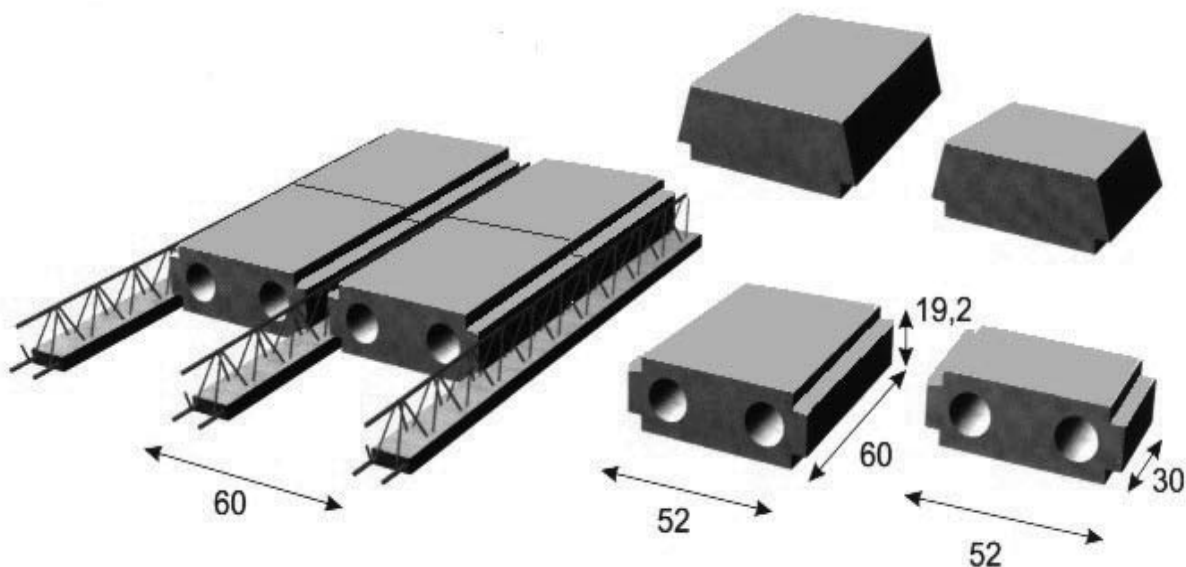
Часторесбистое перекрытие (балки «Терива» и пустотелые блоки из АЯБ) [3]
